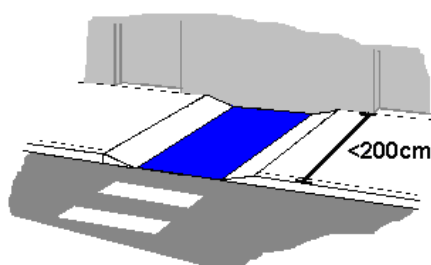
Pavimento tátil no rebaixamento do passeio ao longo da largura da passagem de peões
